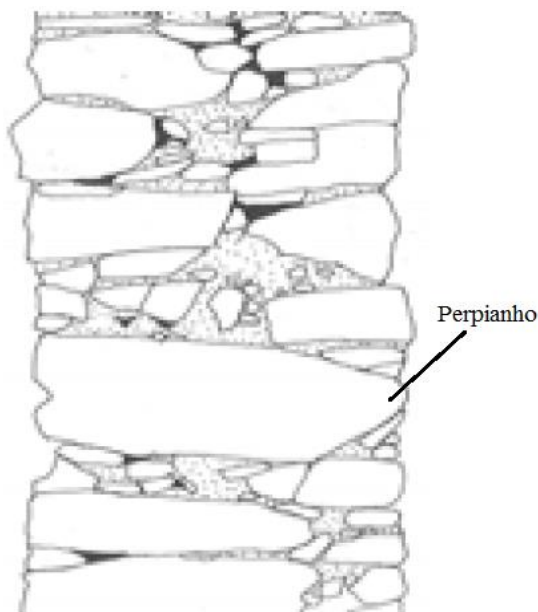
Exemplo de perpianho (ou travadouro) numa parede de alvenaria [12]
